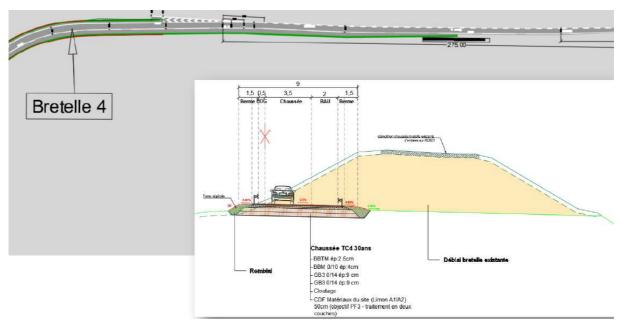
Plan de la bretelle n°4 de la solution retenue pour le projet
